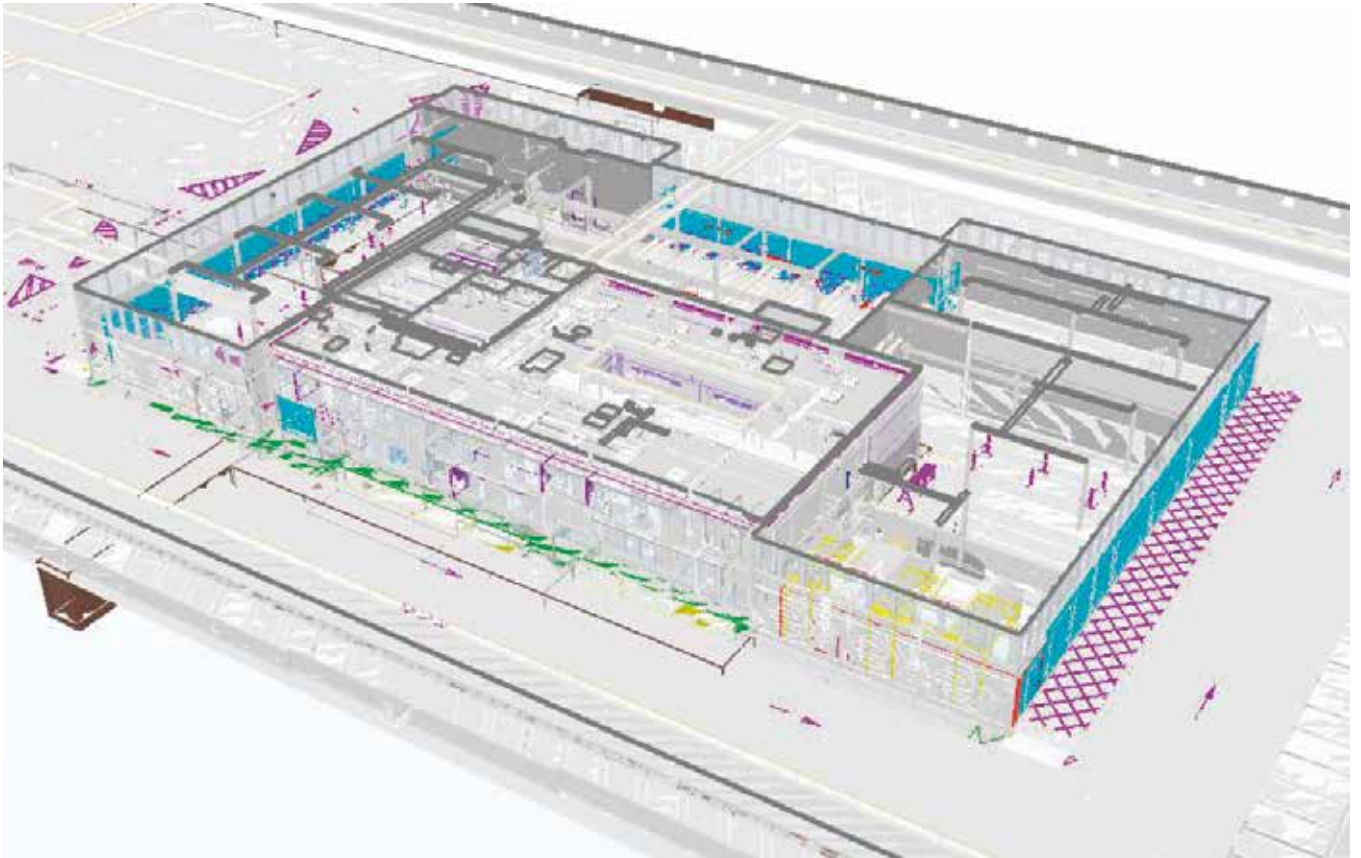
\_ Vista del modelo BIM. Fuente: proyecto original
